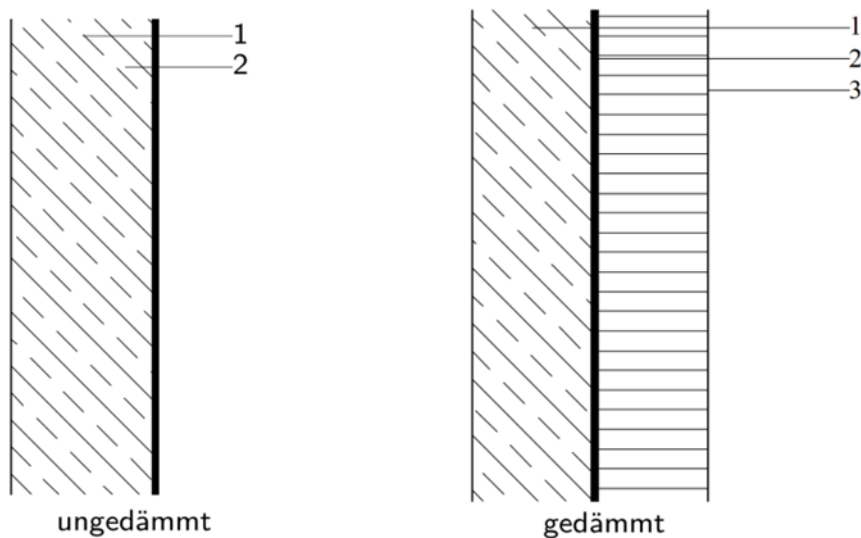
Bauteilaufbau der Variante K02, Wand, gedämmt/ungedämmt
